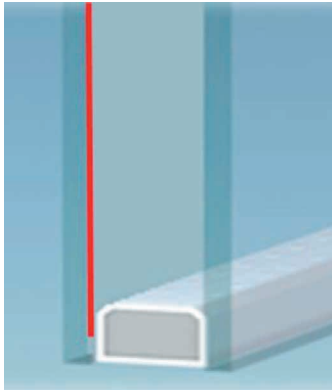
Doble acristalamiento (ATR) SGG CLIMALIT PLUS con PLANITHERM 4S.
